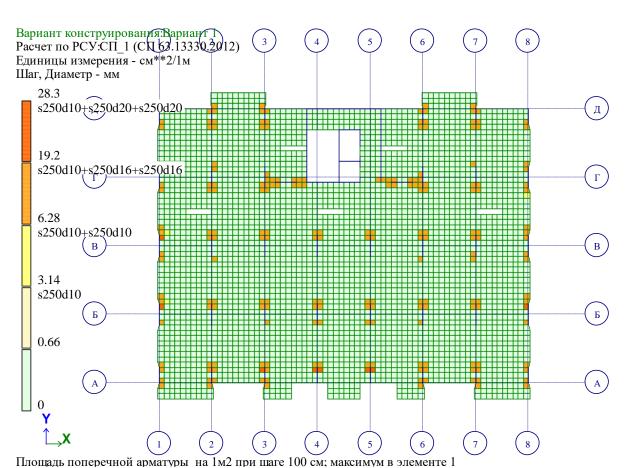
Расчетное армирование плиты над первым этажом поперечной арматурой.
